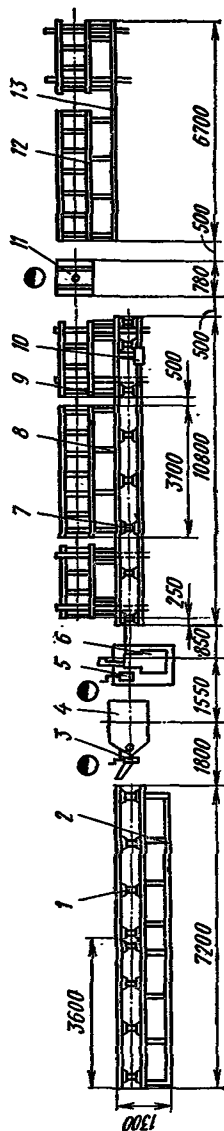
Схема организации рабочих мест у установок для безотходной стыковой сварки, резки и гибки арматурных стержней:
